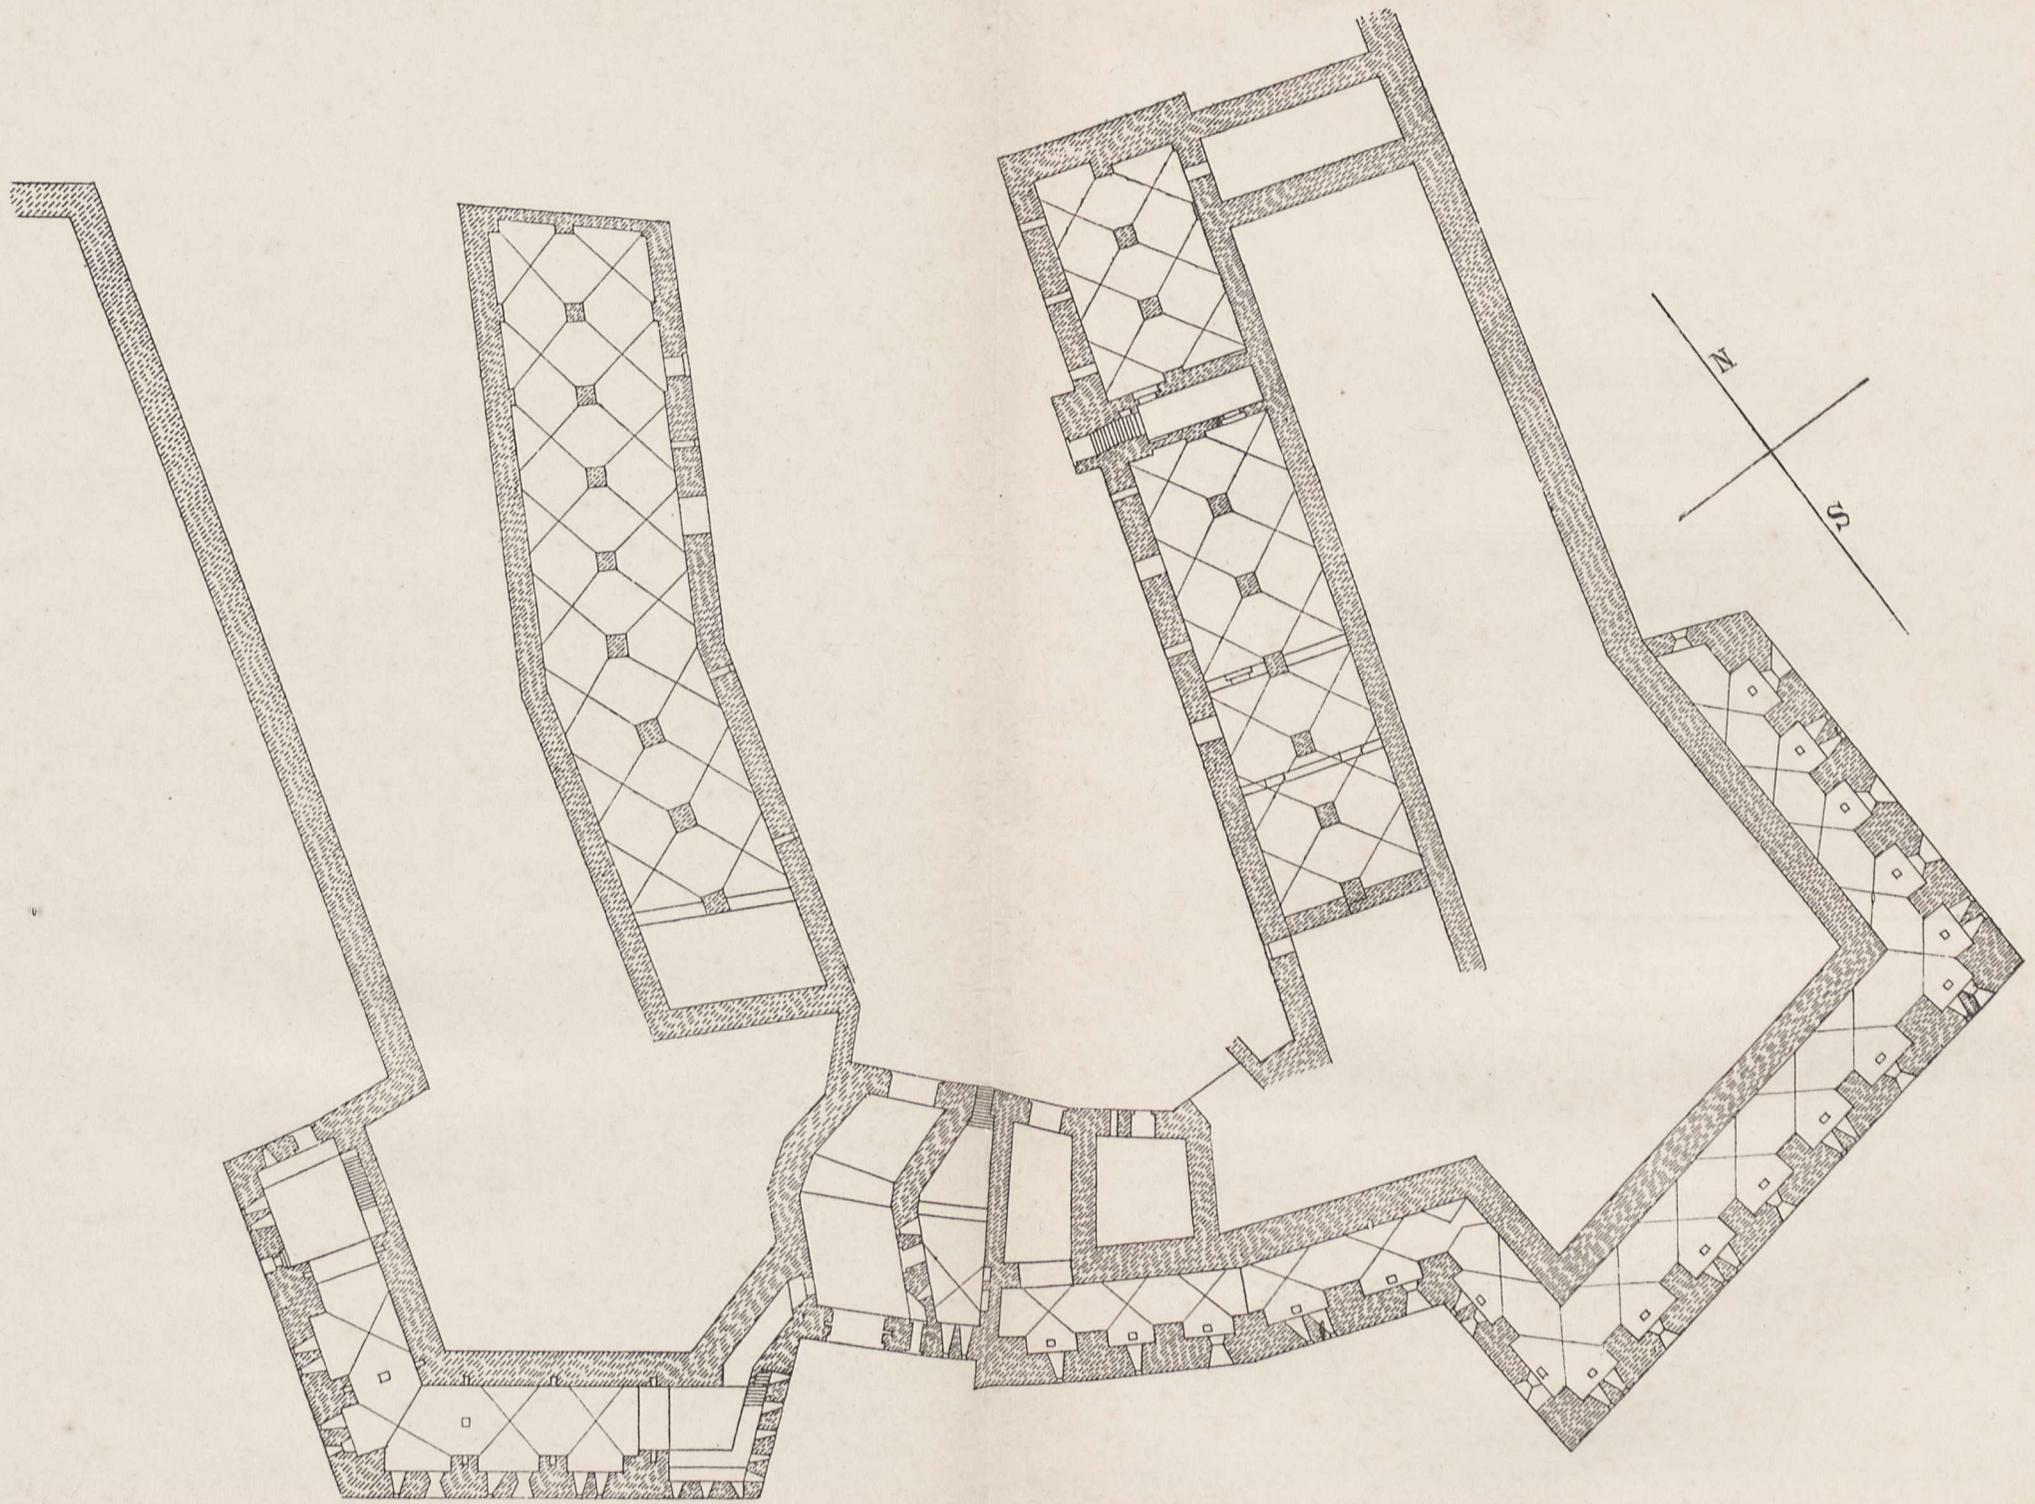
Spantekow; Schloss, Grundriss der Kellereien und Kasematten und des südwestlichen Theiles der Umwallung. 1 : 500.
